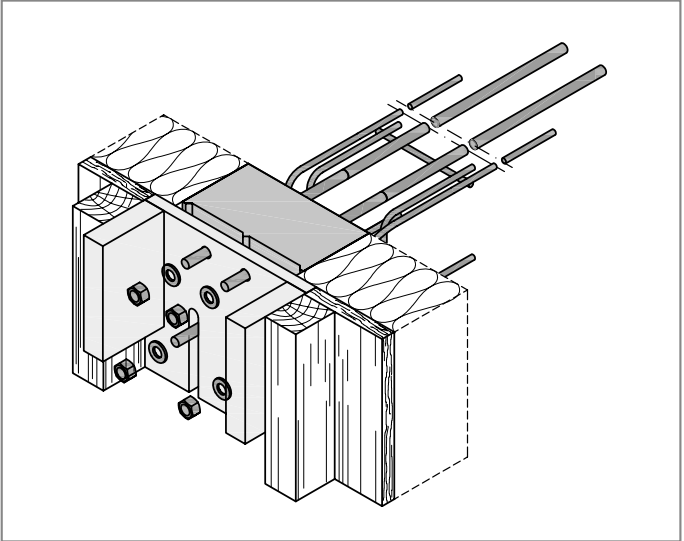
Schöck Isokorb® XT Typ SK: Einbauhilfe umgekehrt eingebaut, um bei monolithischer Wand die lückenlose Deckenranddämmung zu ermöglichen
